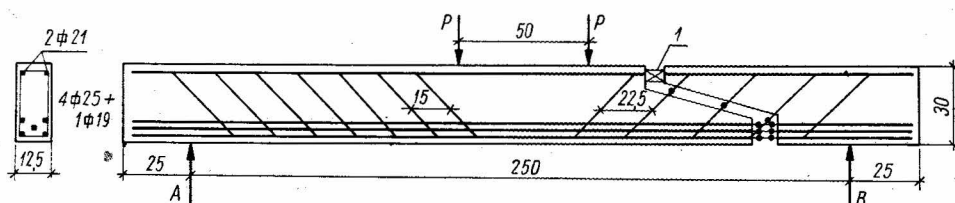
Poutre en béton armé avec une fissure oblique artificielle dans les essais de JONES
